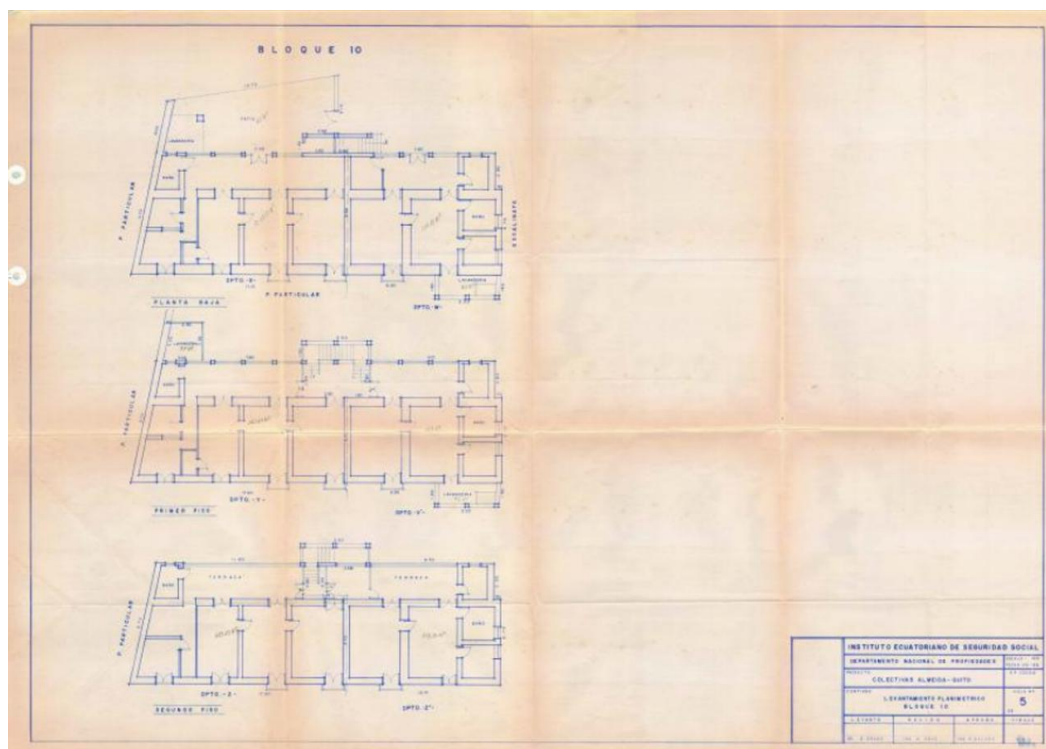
Colectiva Almeida, Levantamiento Planimétrico Bloque 10
